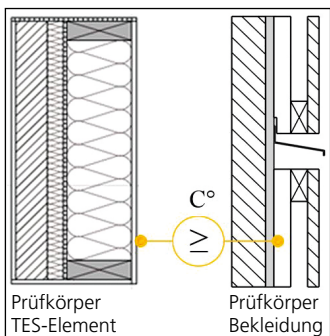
Vergleich der Prüfkonfiguration zwischen den Versuchen mit Holz-Fassadenbekleidung und dem TES-Element
